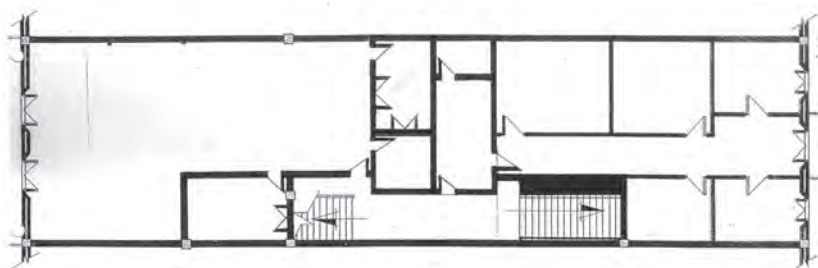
17. 1989 PLANTA PRIMERA ANTERIOR A REFORMA
